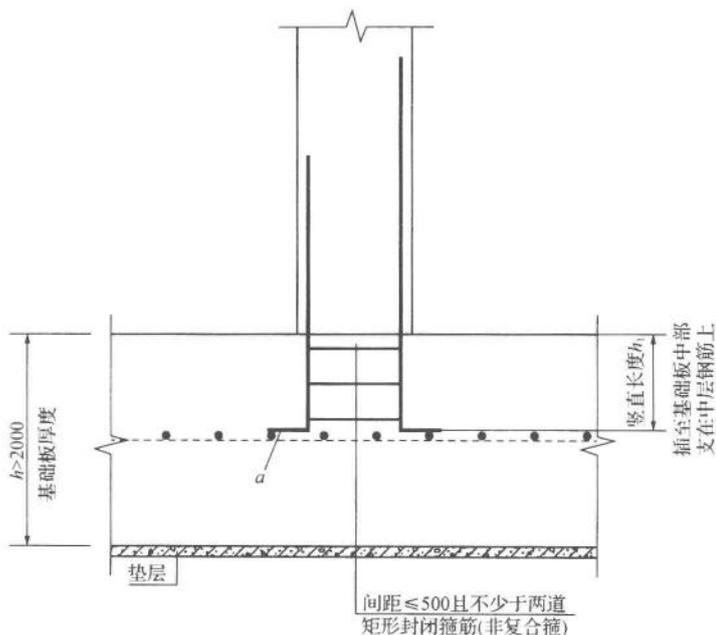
柱插筋在基础平板的锚固构造示意图(基础板底部、顶部与中部均配置钢筋网)
